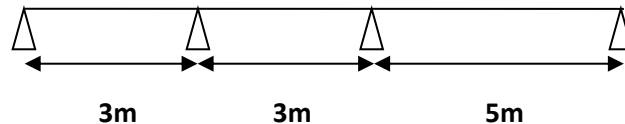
Schéma du 2^{ème} type de poutrelles
